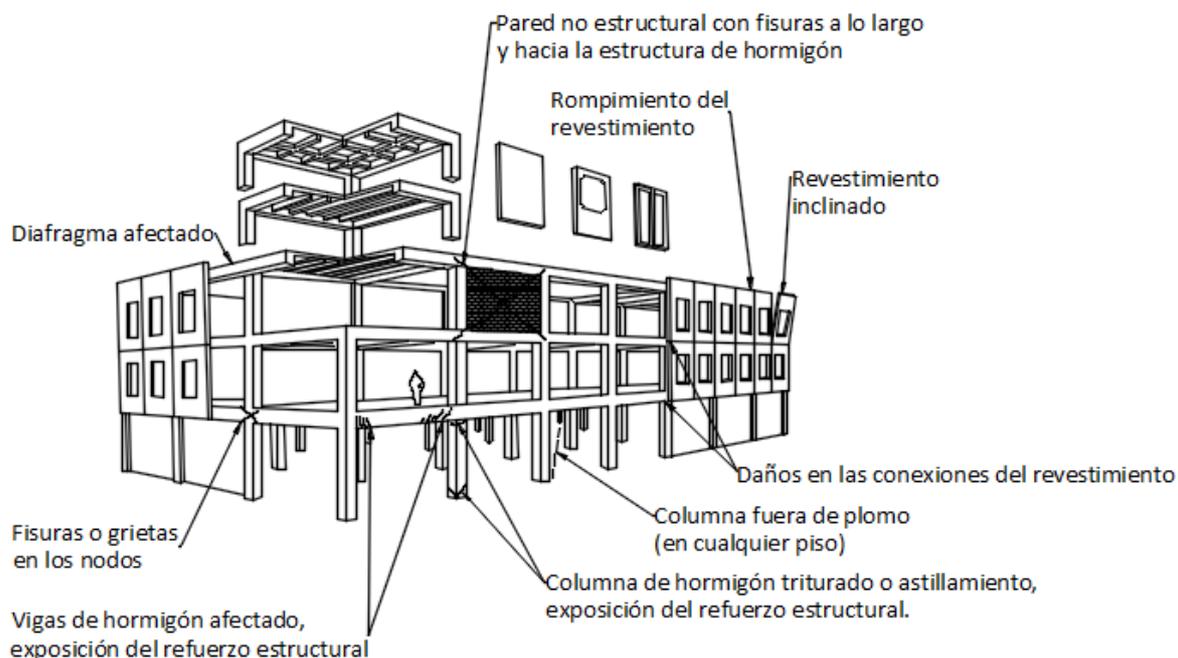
Puntos de inspección para edificaciones con sistemas estructurales a porticados de hormigón armado
